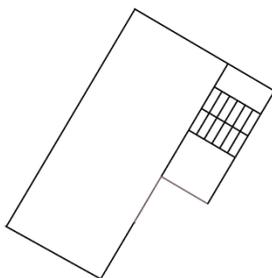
Schematischer Grundriss Multifunktionshalle
